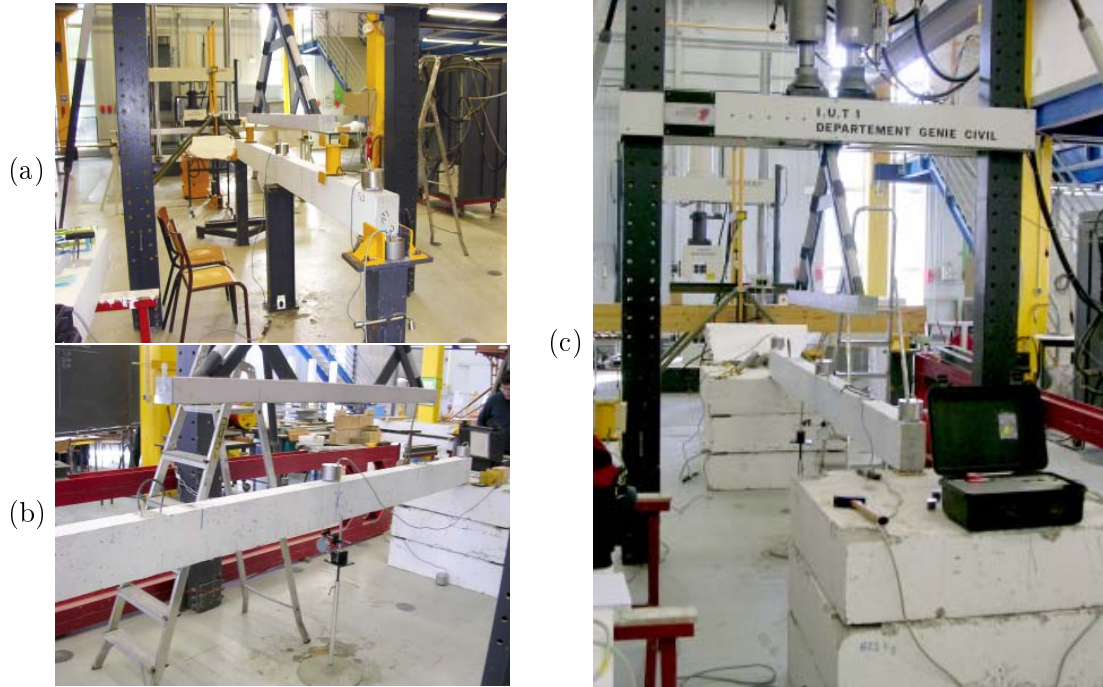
Vues des poutres sous la presse durant la mesure de bruit de fond. La poutre repose soit sur des profilés métalliques verticaux (a), soit sur l'empilement de trois blocs de béton (b) et (c).
